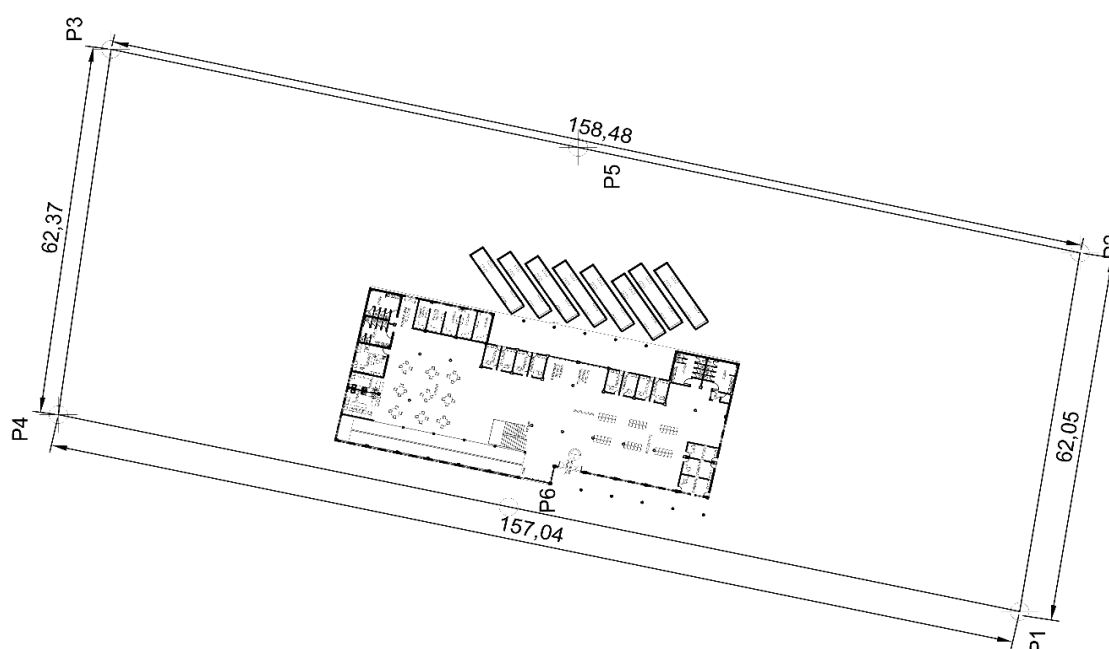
Proyección de la estructura en el lote (fuente: elaboración propia)
